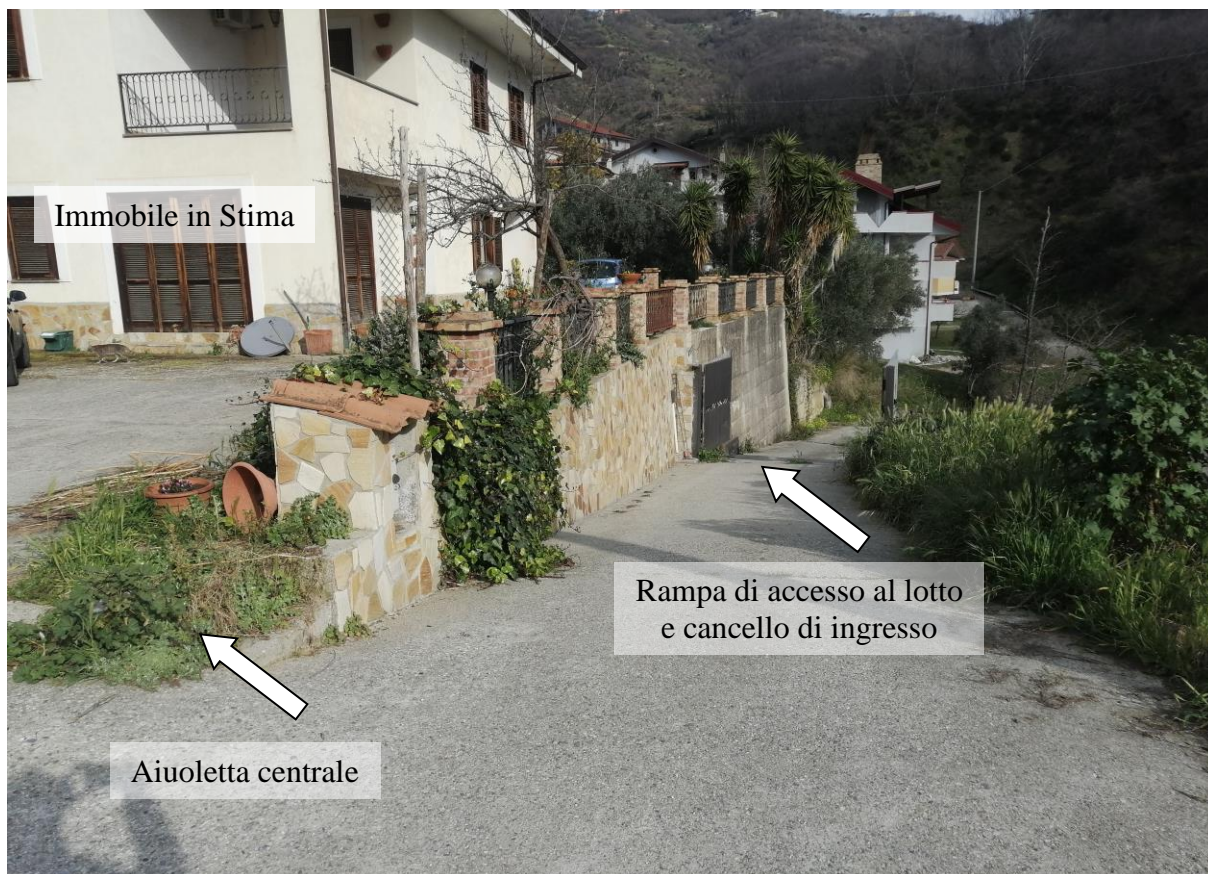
Accesso al Lotto e vista dell'immobile in stima
